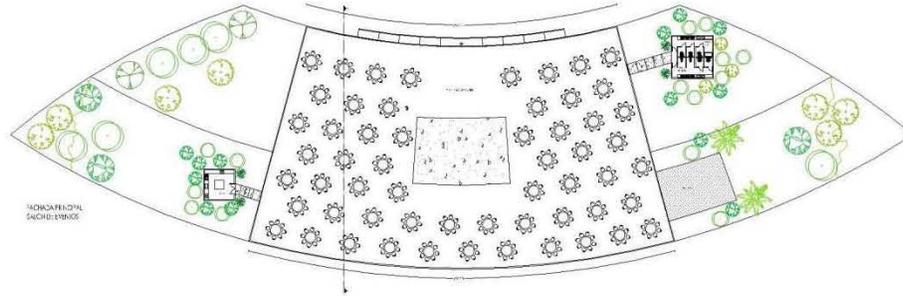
Planta Arquitectónica del Salón de Eventos
